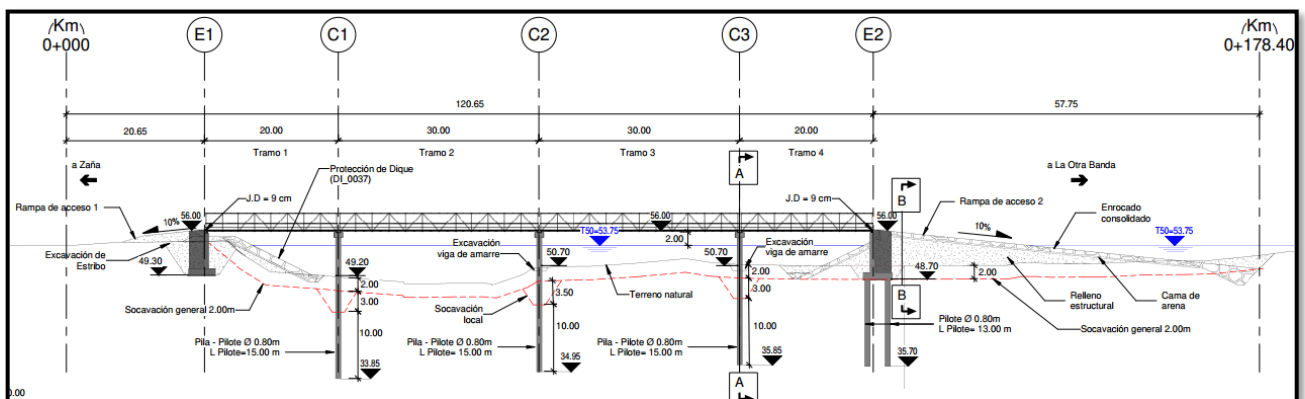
Perfil longitudinal puente colgante la Otra Banda-Zaña.
